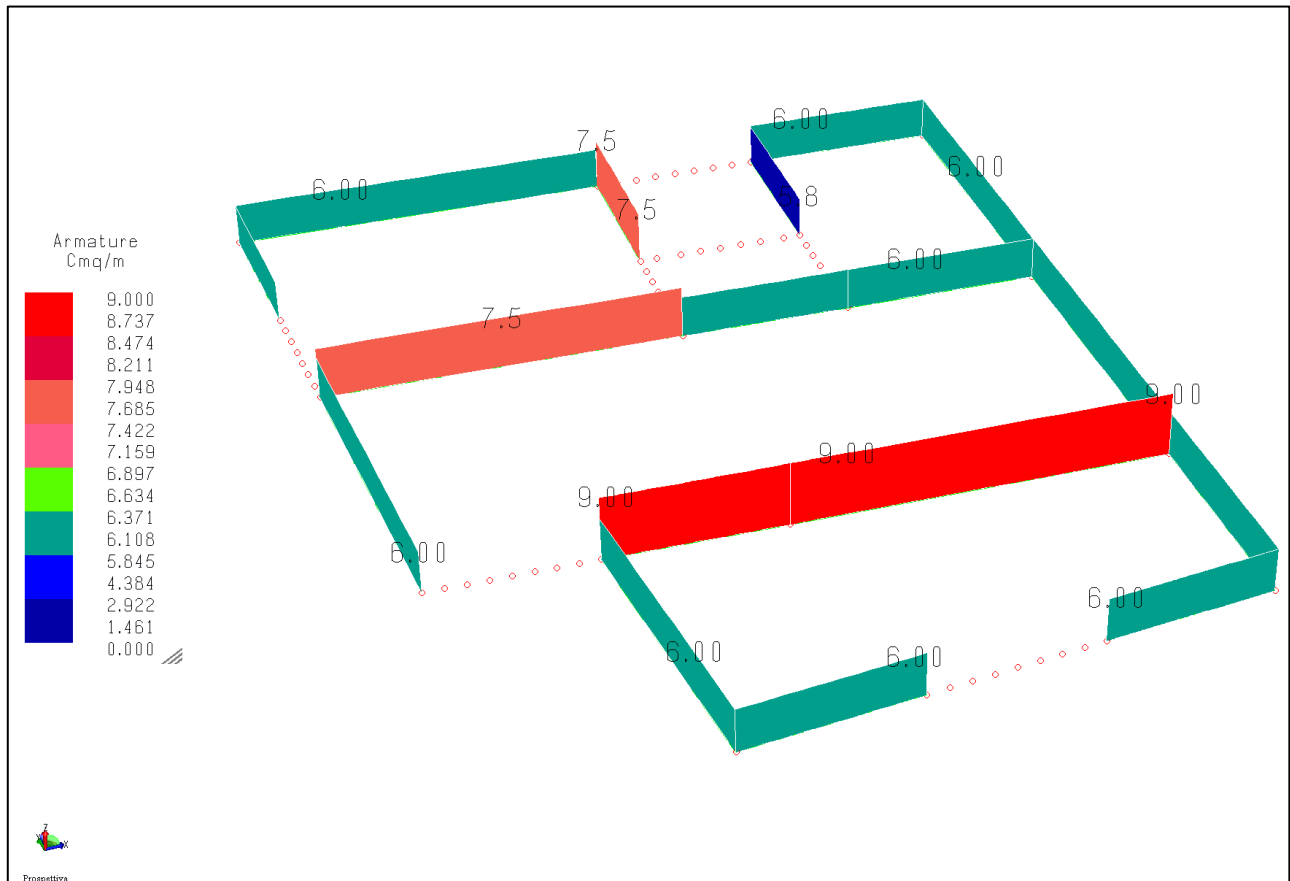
armatura trasversale sulle travi del primo solaio (cmq/m)
